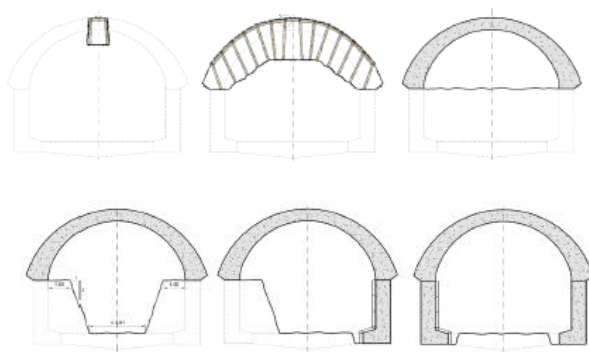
procés constructiu d'un túnel segons el mètode belga [Font: Proceso constructivo y plan de obra, 2018]
